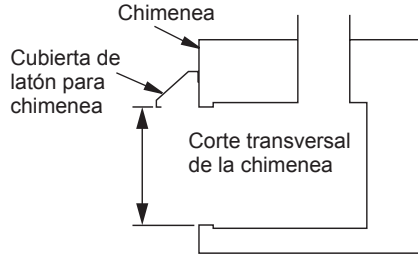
Ubicación de la cubierta en una chimenea de mampostería
